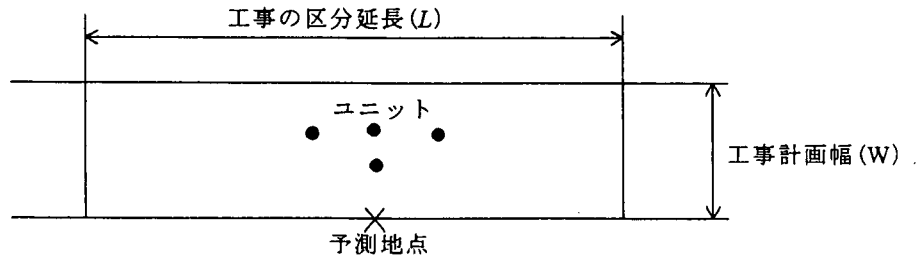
施工範囲が特定される場合の施工範囲とユニットの配置例
